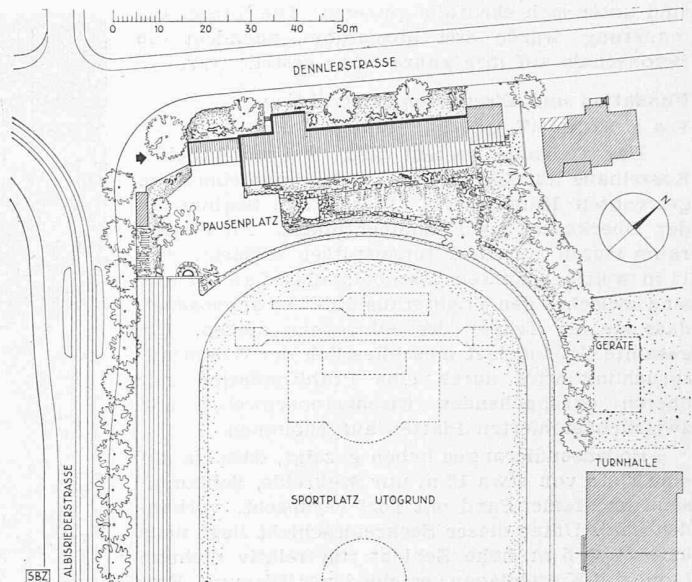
Schulhaus Utogrund, Lageplan 1:1600
